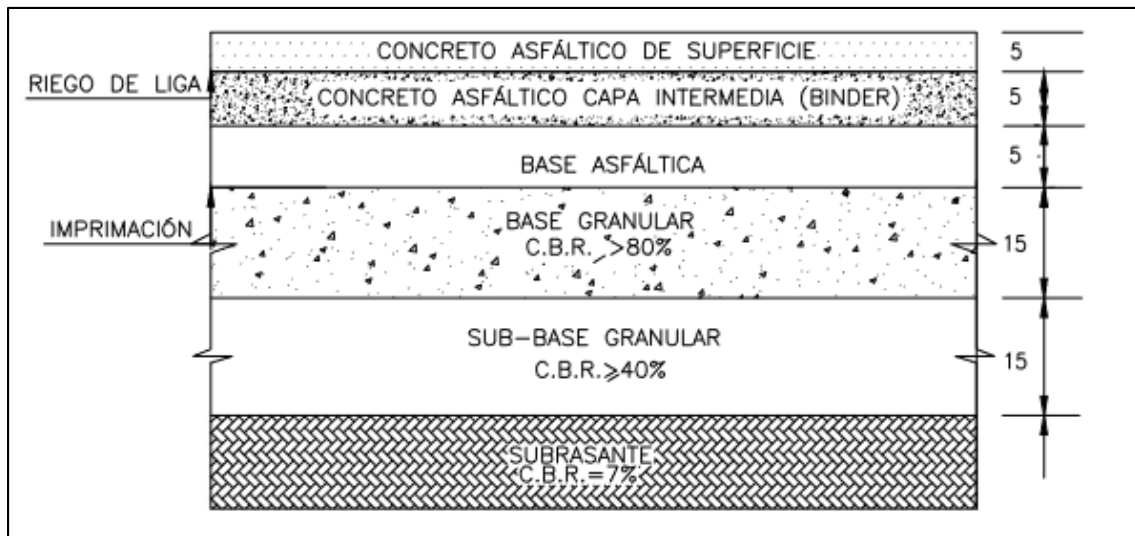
Perfil longitudinal del paquete estructural de la Ruta F-50.
